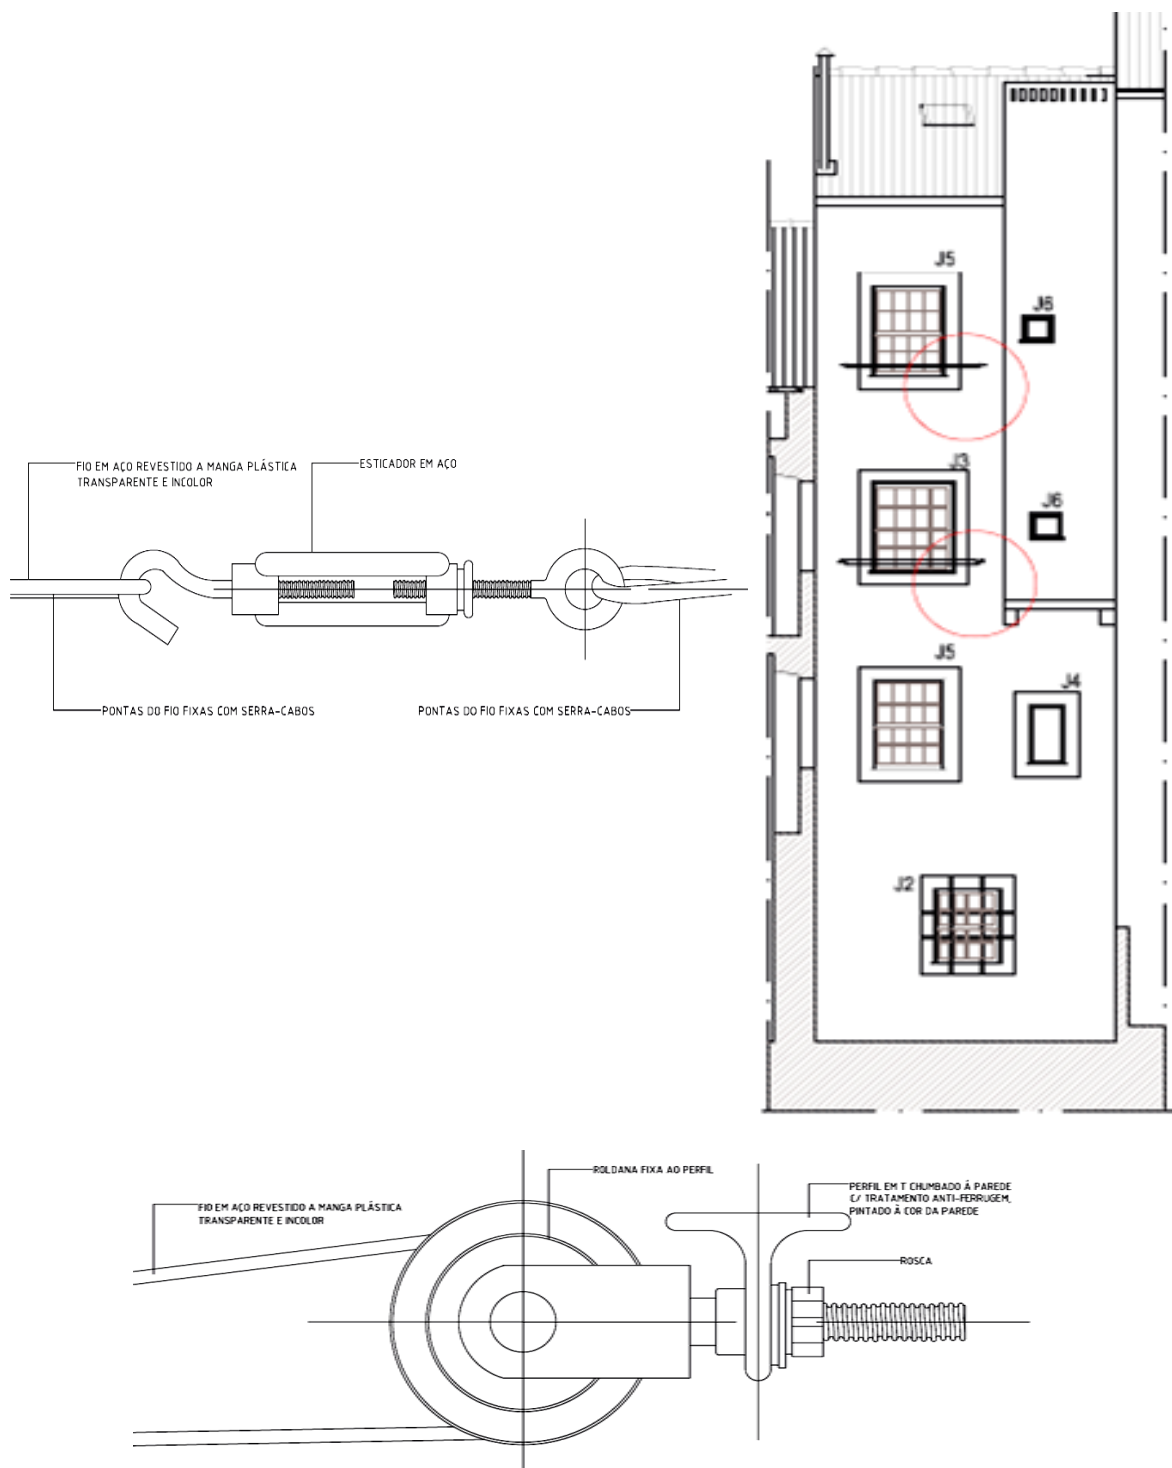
Desenho de pormenor tipo do GTL, fixação para estendal.
